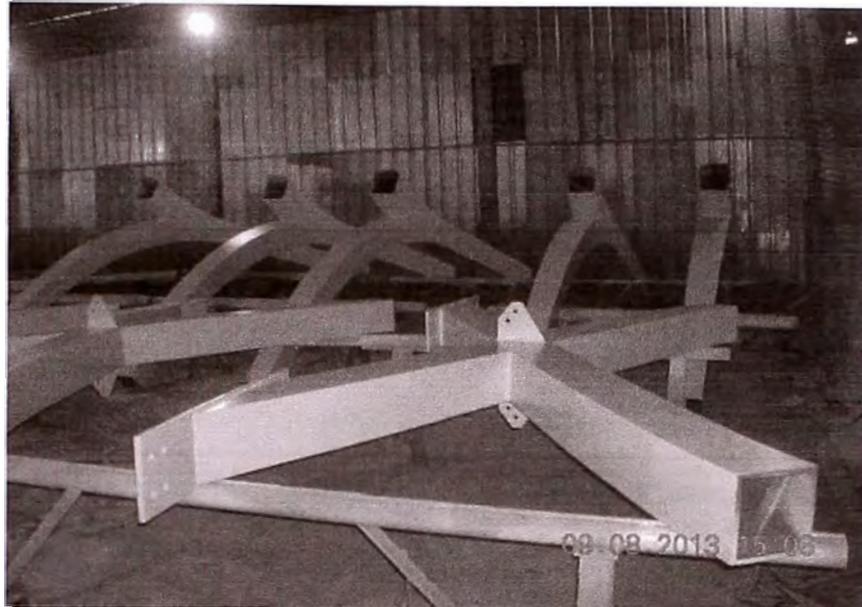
Columnas y aspas en segunda capa de pintura
